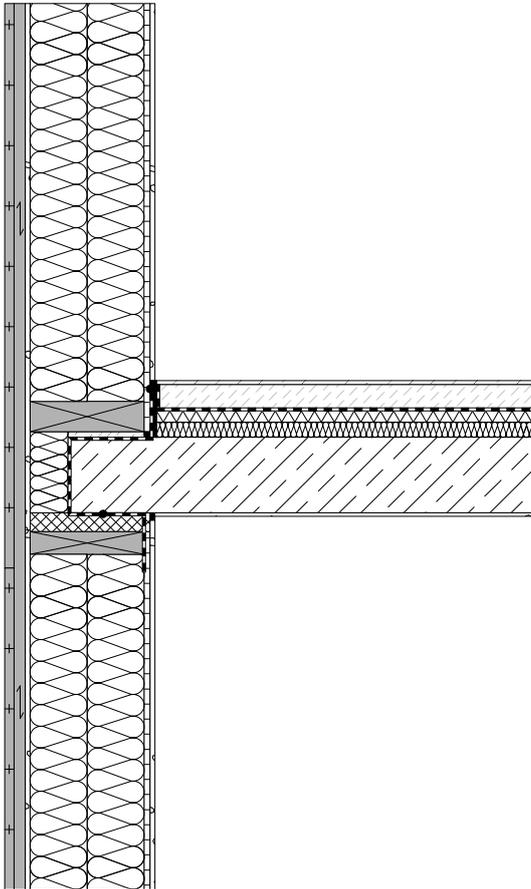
Anschluss Außenwand WA3-3 - Geschossdecke DE1
